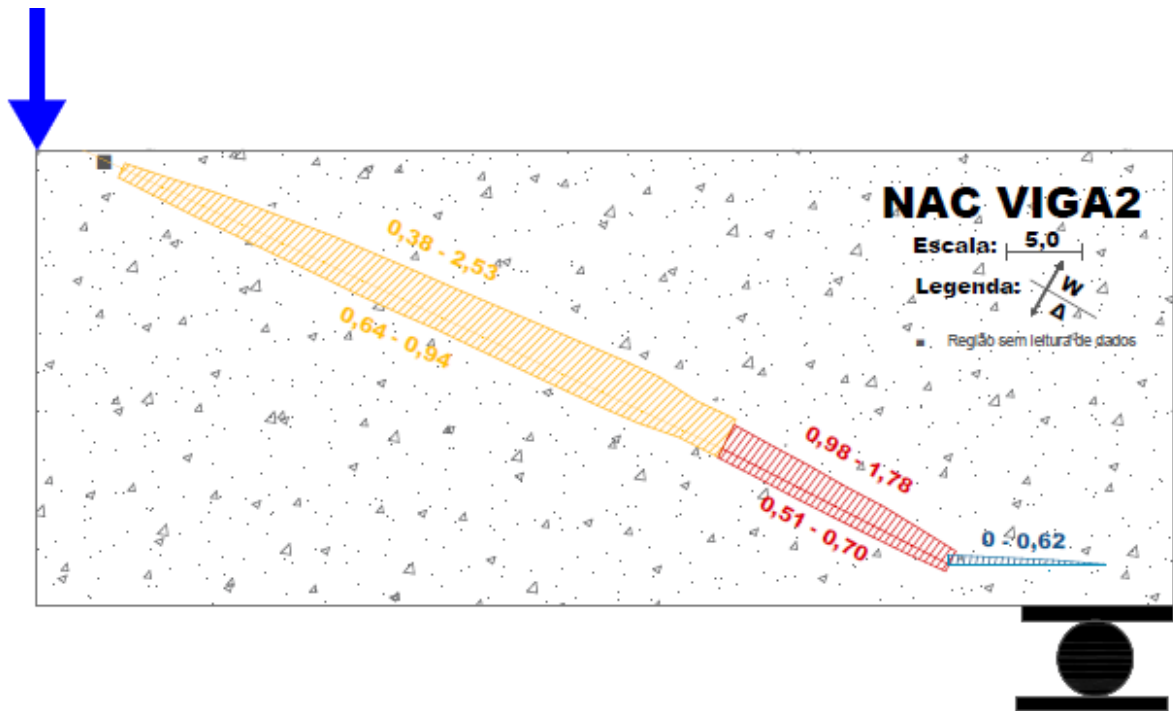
Abertura (w) e deslizamento (Δ) da fissura diagonal crítica da viga NAC-2.
